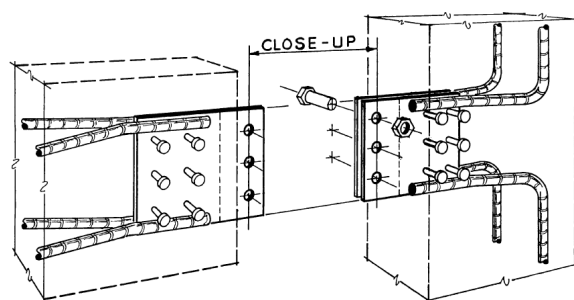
Representação esquemática da ligação viga-pilar “*knife connection*” (Brikeland e Brikeland, 1966)
